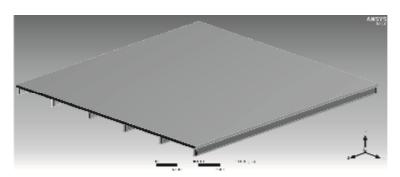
Модель сталежелезобетонной плиты с ребрами из гнутых профилей
